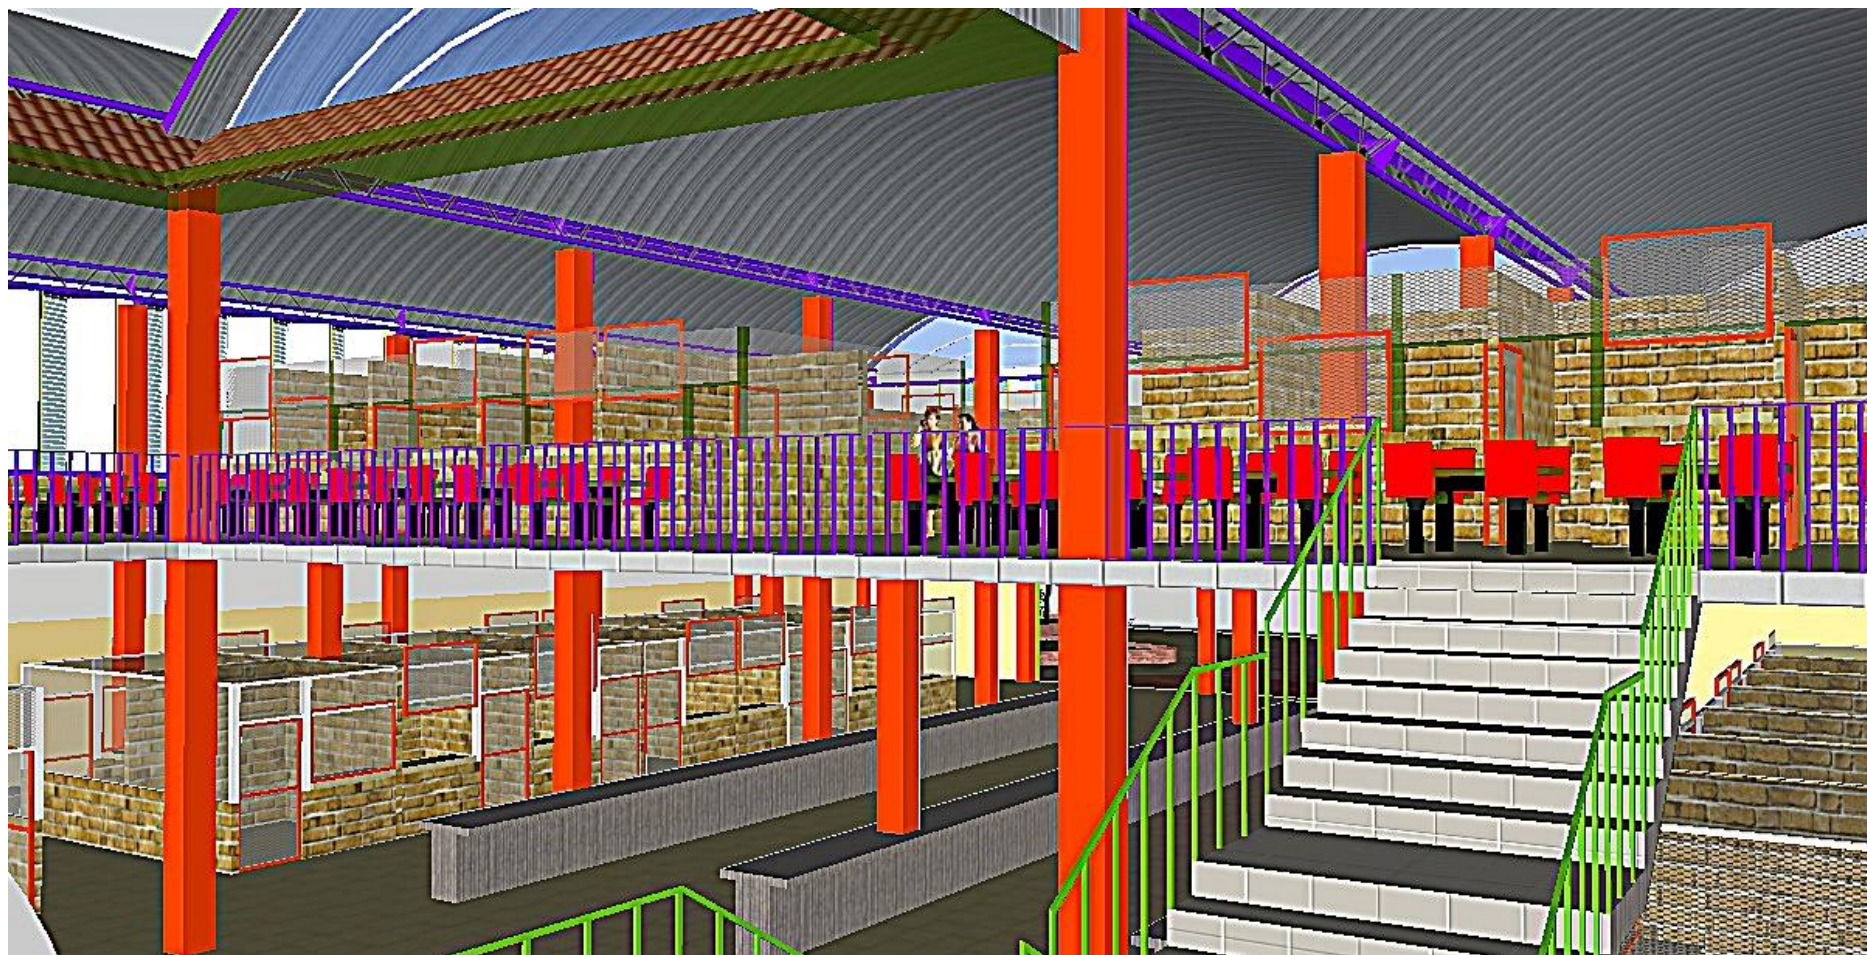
Vista interior de gradas, arriba puestos de Pupusería, abajo planchas de ventas de verduras no permanentes.
